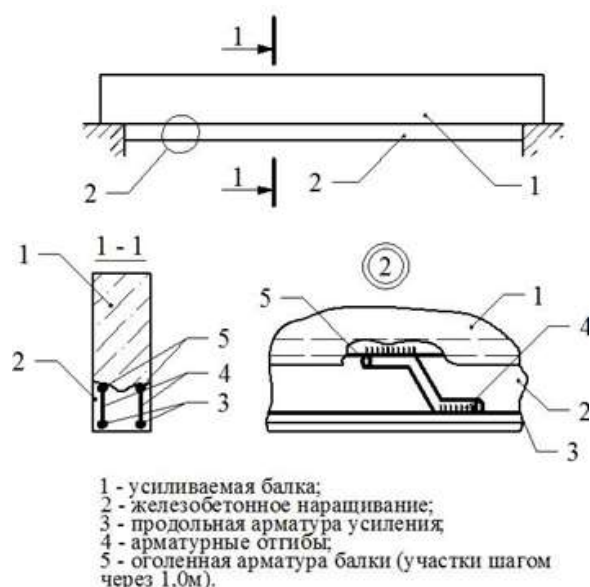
Усиление железобетонной балки путем её железобетонного наращивания снизу
